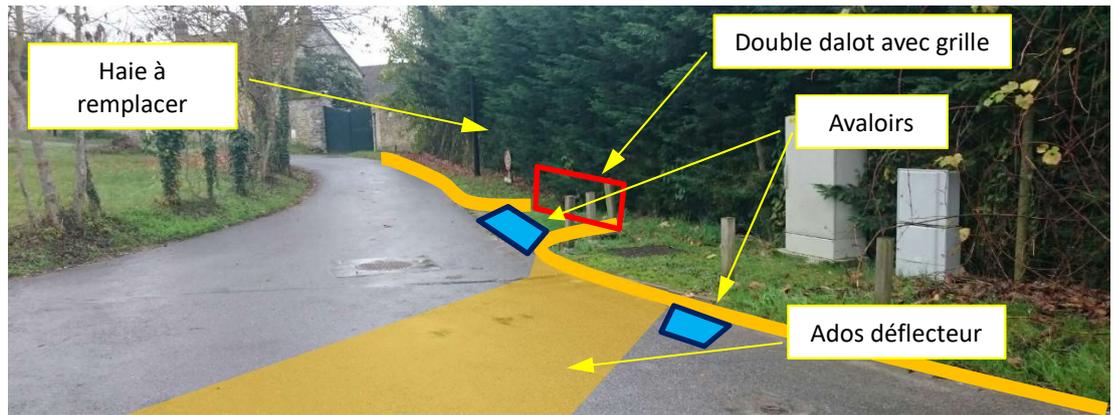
aménagement au droit du carrefour de la rue de la Grand'Mare et du chemin de la Corneille
